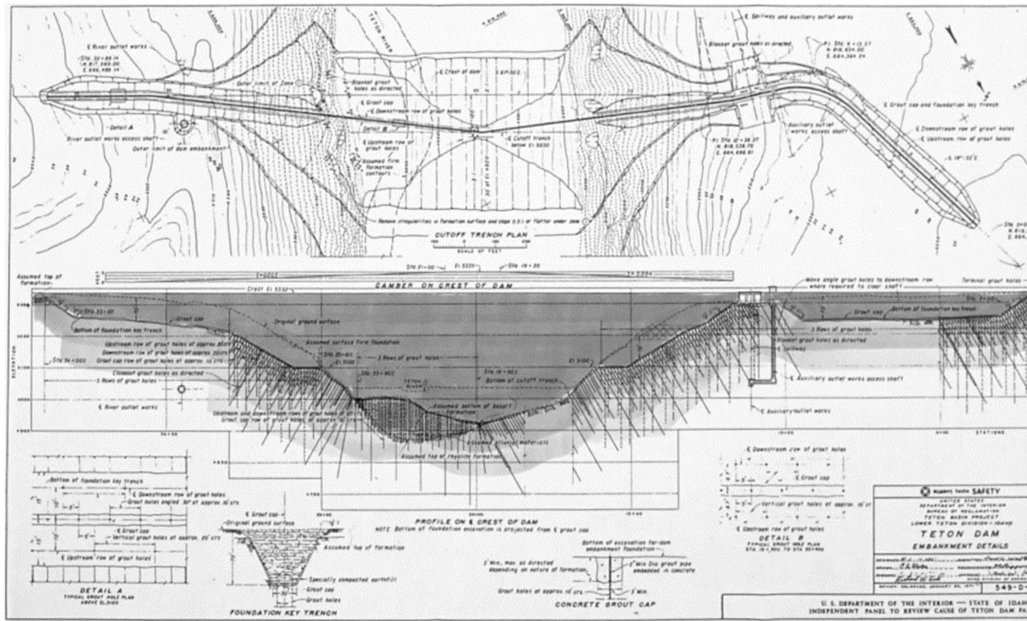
Planul și secțiunea longitudinală a barajului Teton.
